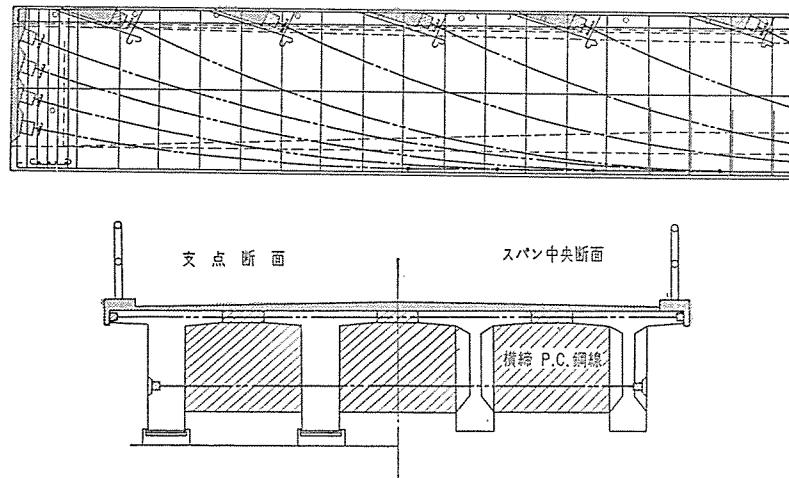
プレキャストで製作された PC 橋の断面図および配筋図
